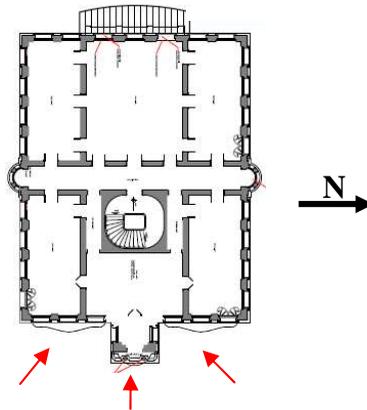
Pl. Baixa identificando a Fachada Principal – Paço Municipal
